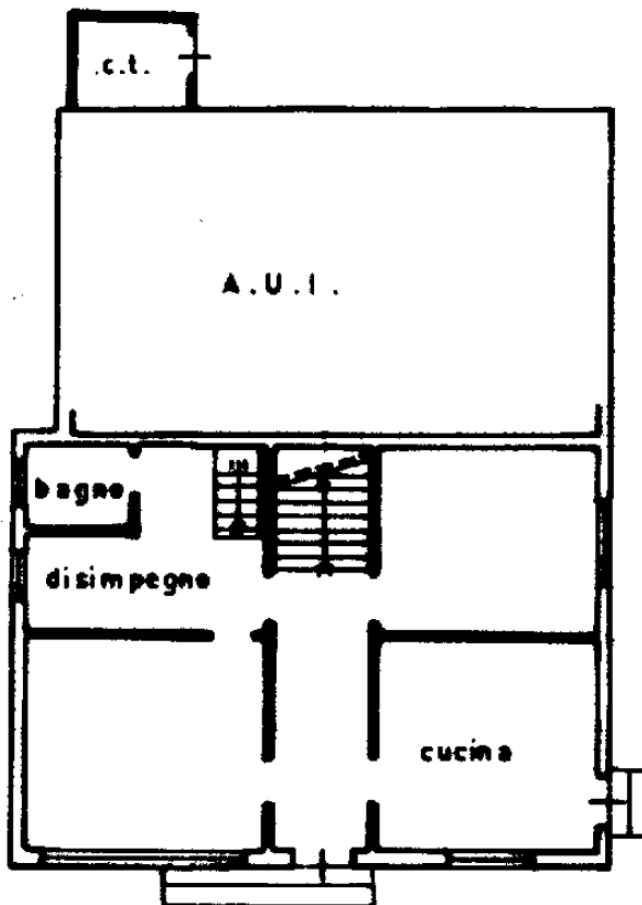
Planimetria catastali dei beni (sub. 6, p.t.).
